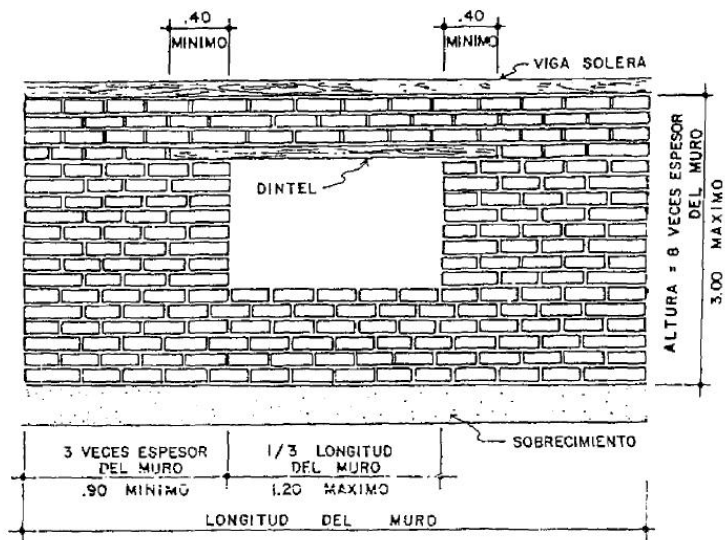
Recomendações para a construção de muros em adobe. *In Manual para la Construcción de Viviendas de Adobe
